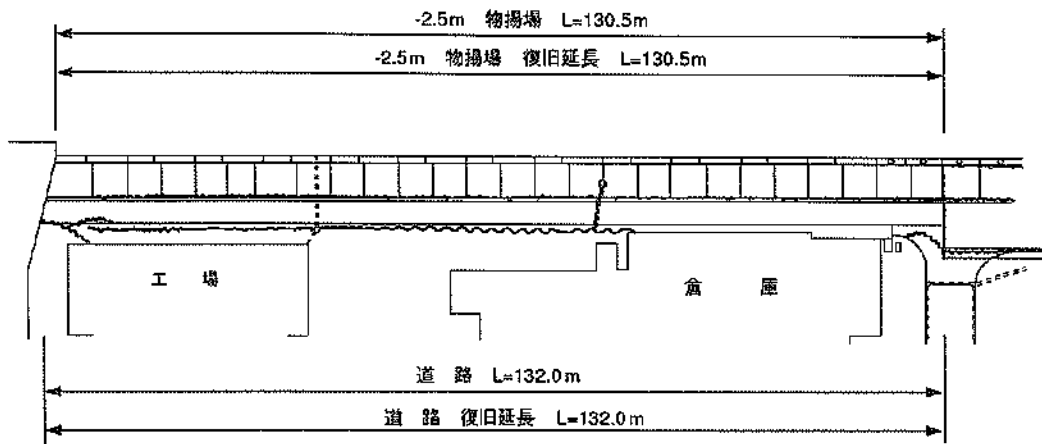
厚岸漁港（湖北地区）③-2.5m物揚場被災状況平面図
